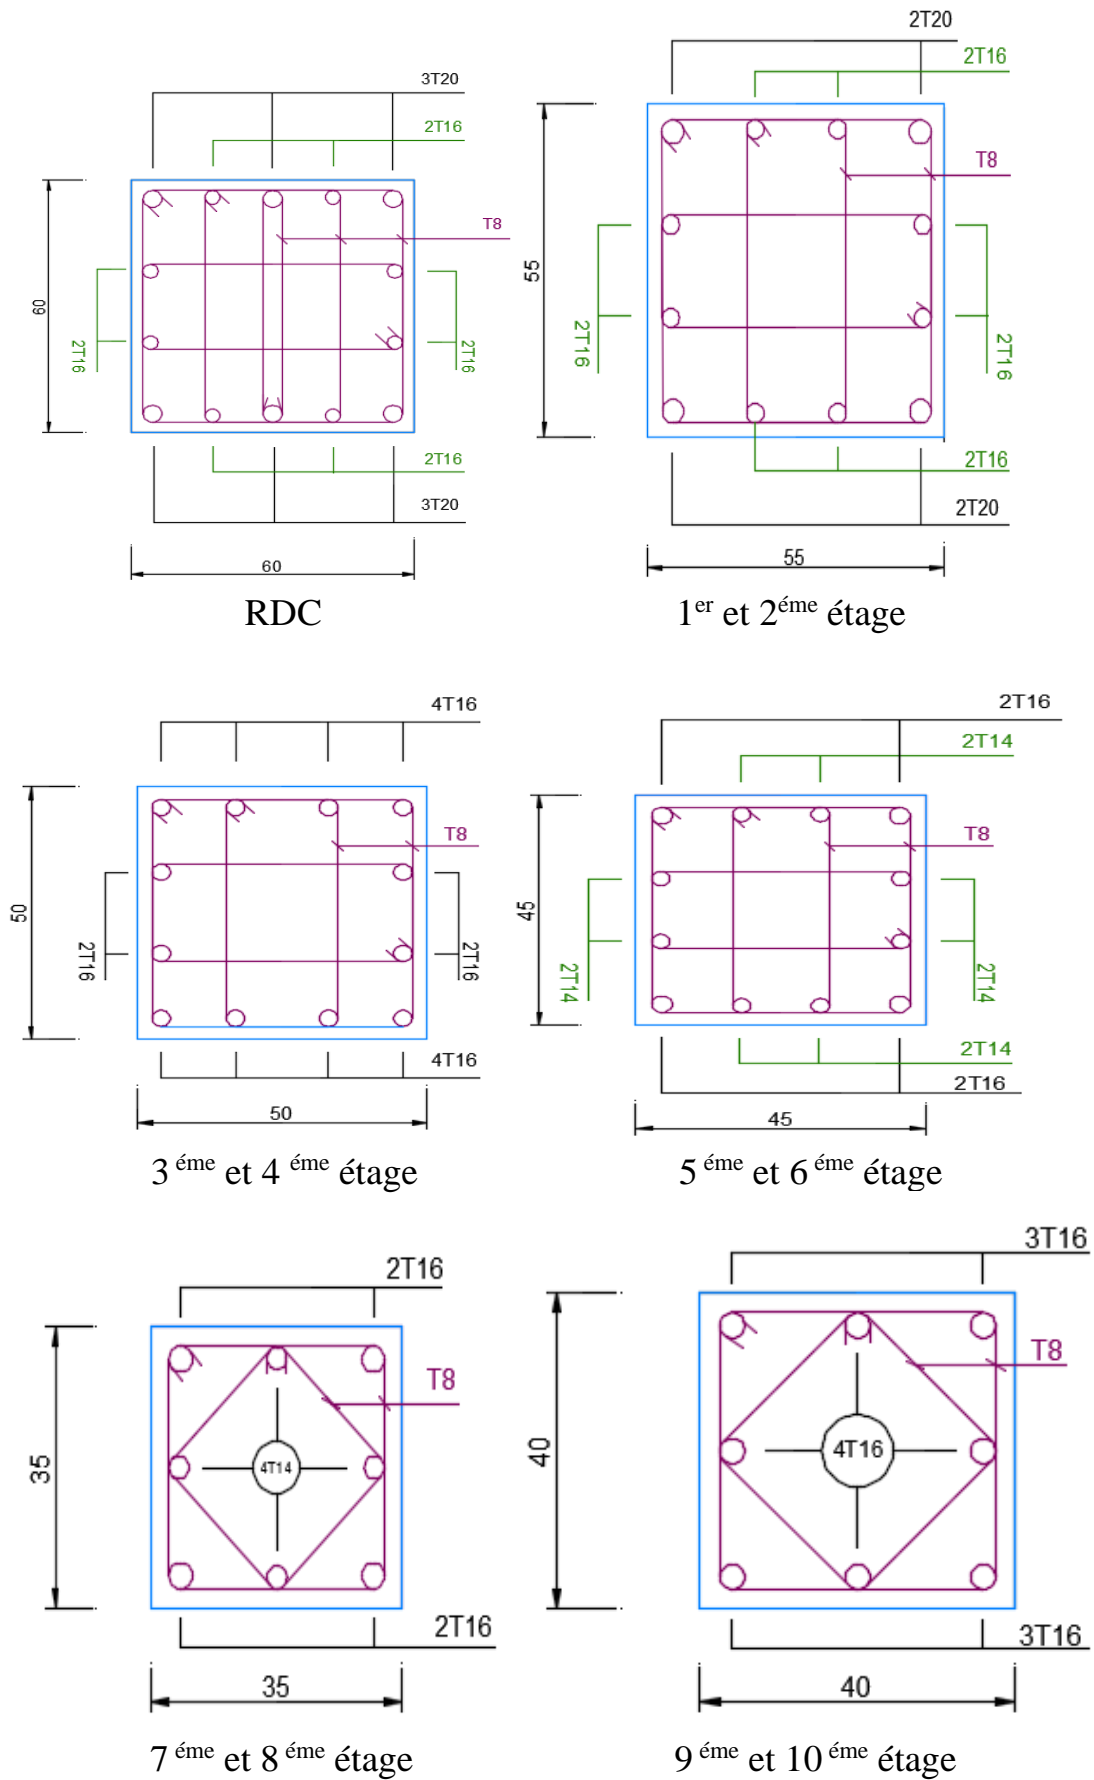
Dessin de ferrailage des poteaux centraux.
